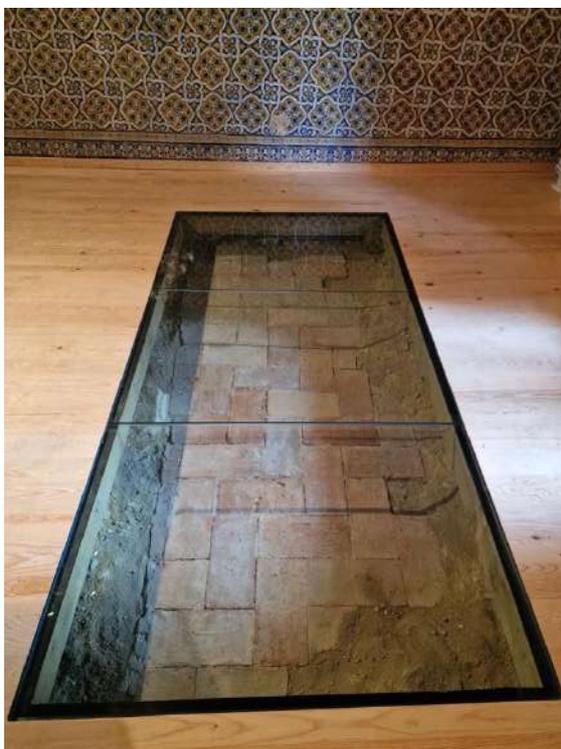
Vista de norte para sul do pavimento pré-existente musealizado.
